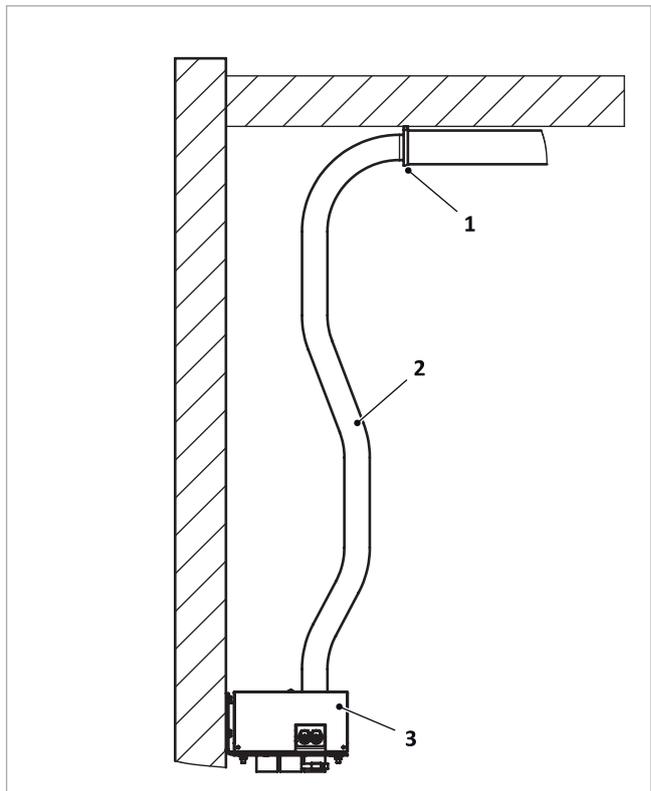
Schlauchbefestigung Decke mit HT-Rohr
